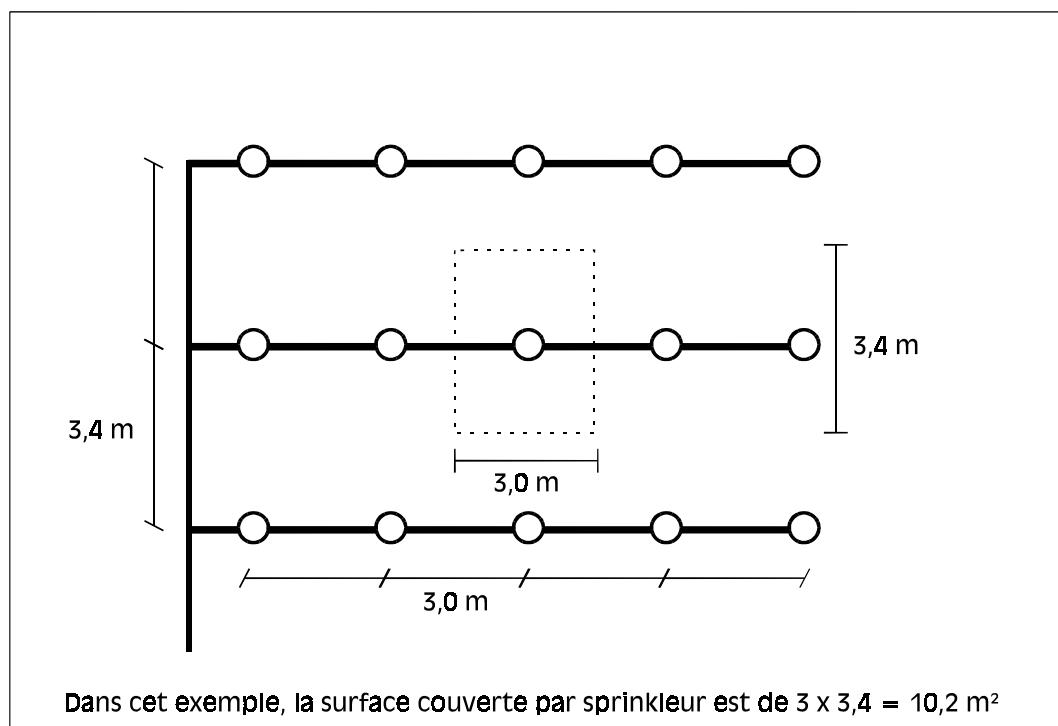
α : RC – exemple de surface couverte par sprinkleur
